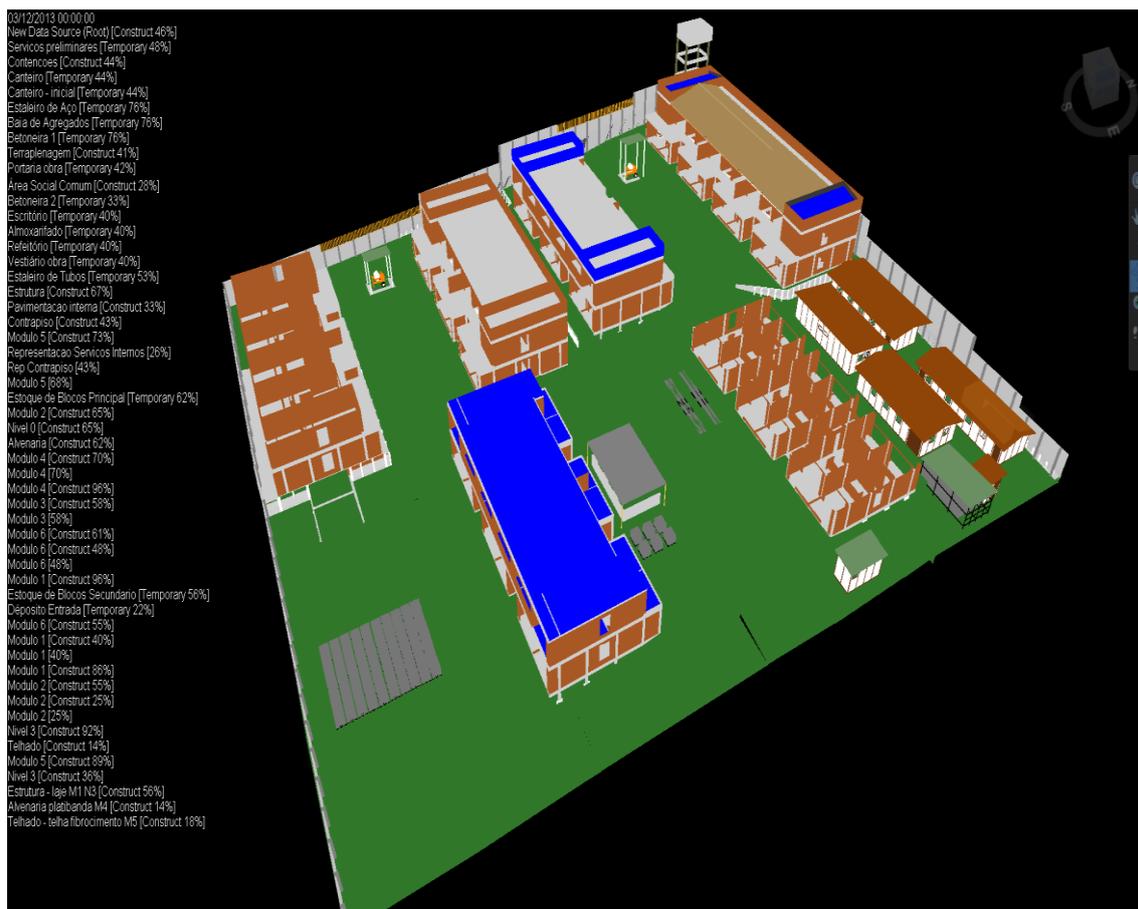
Planejado em 03/12/13: estrutura, alvenaria, telhado e canteiro
